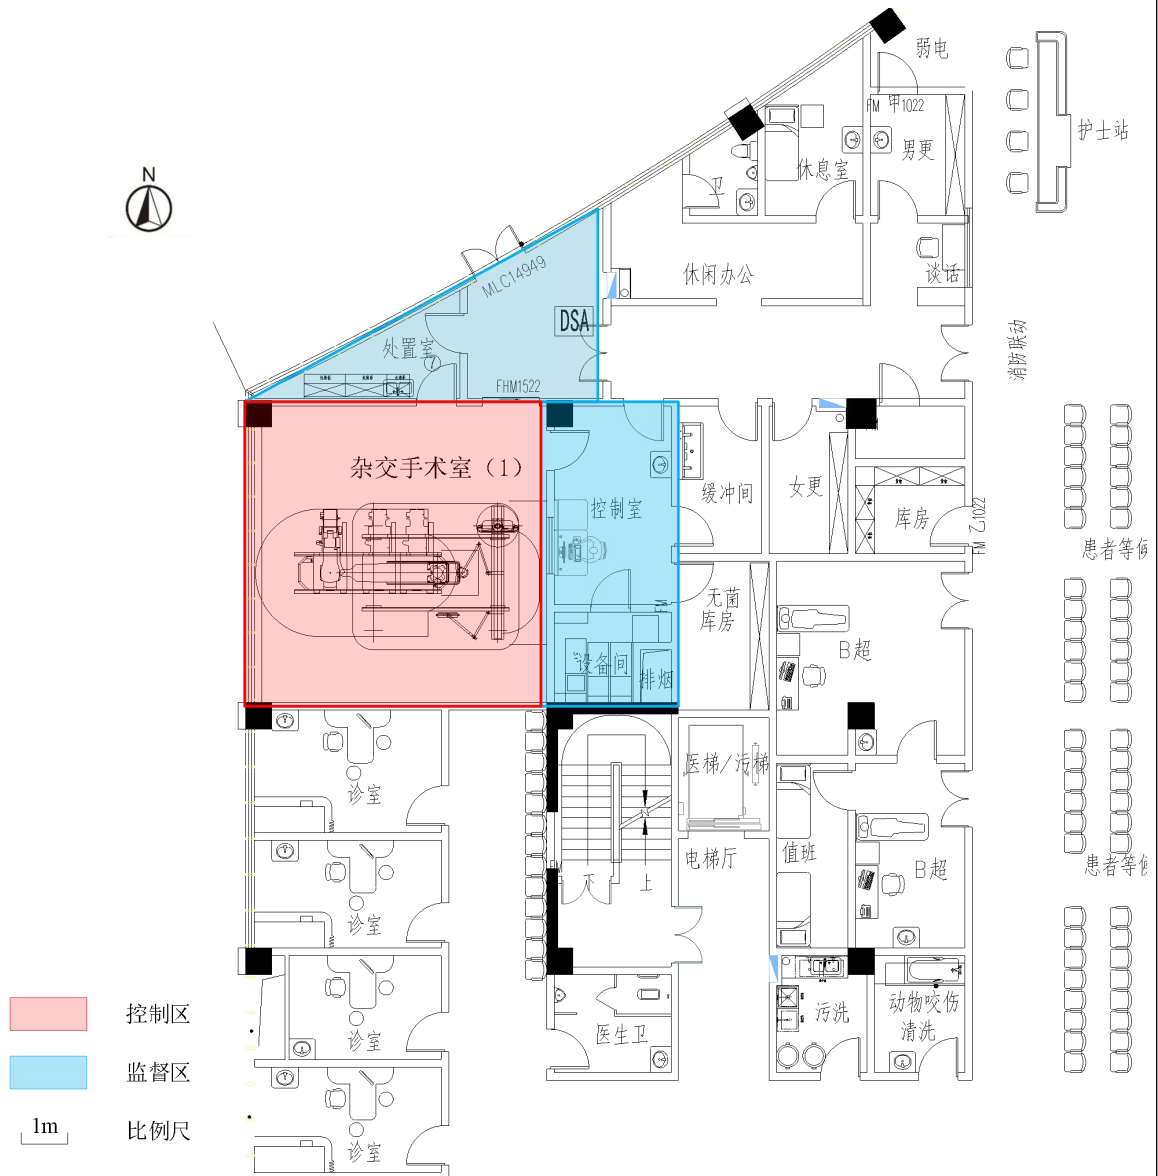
本项目杂交手术室（1）平面布置及分区示意图
